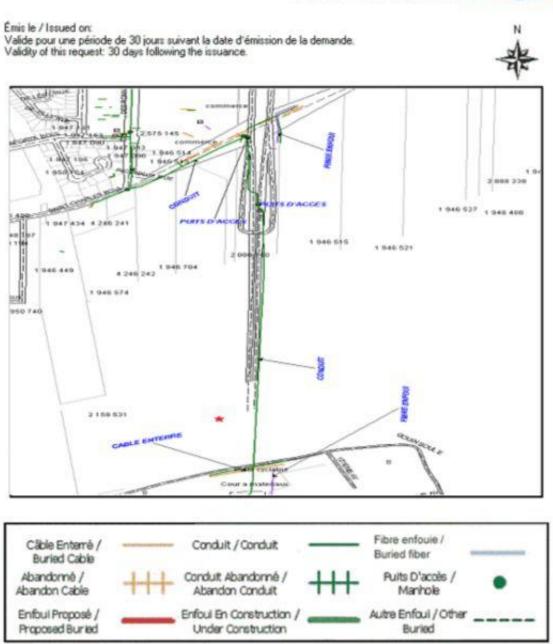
Conduits de Bell, plan reçu par requête info-excavation 2012-09-21
